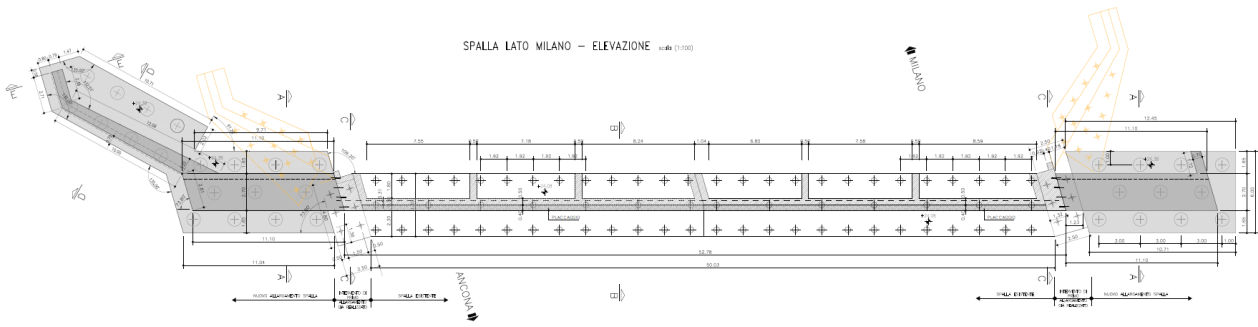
Spalla lato Milano - Elevazione
